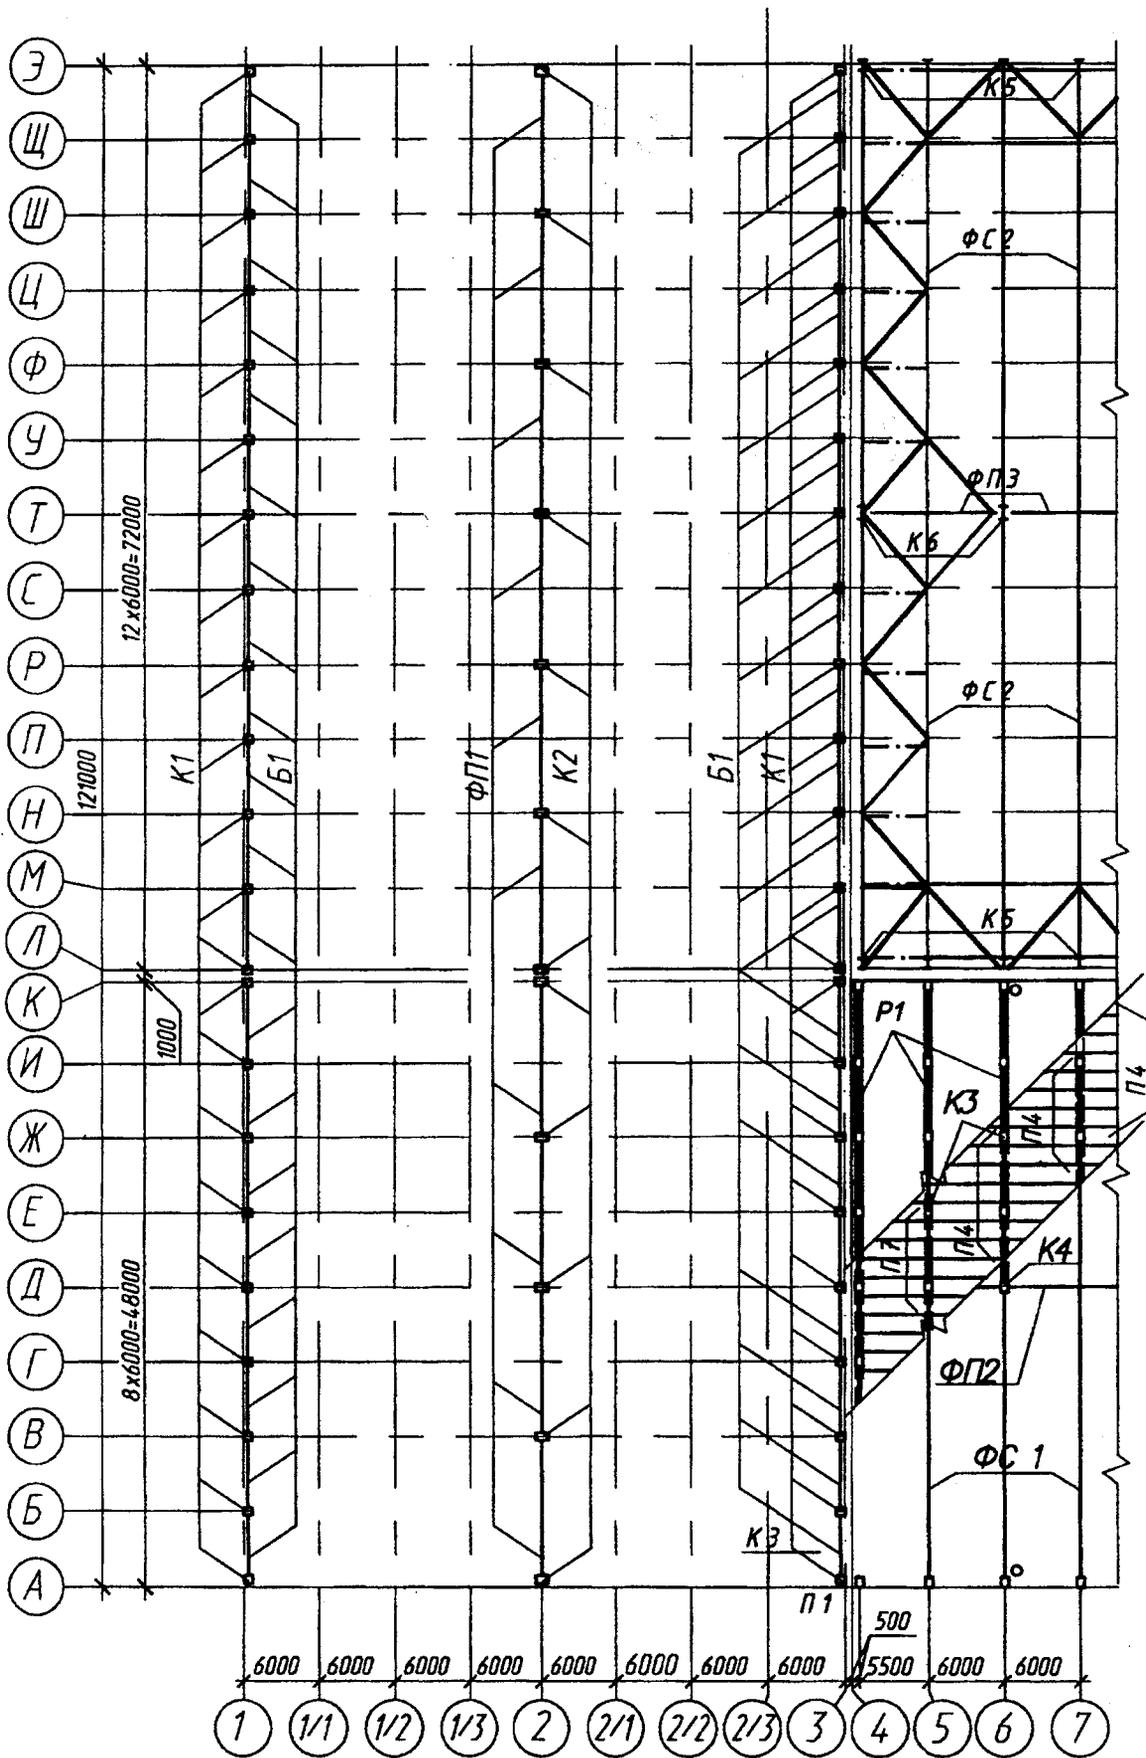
Фрагмент плана несущих конструкций покрытия здания
